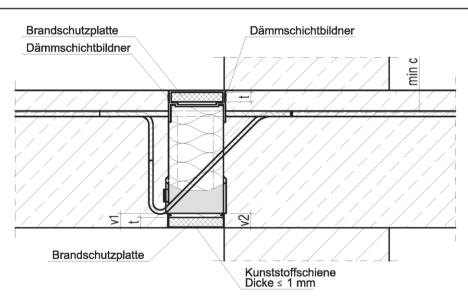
Schöck Isokorb® Typ K und Typ KF (Ausführungsvariante A) gem. Abschnitt 3.1.2
